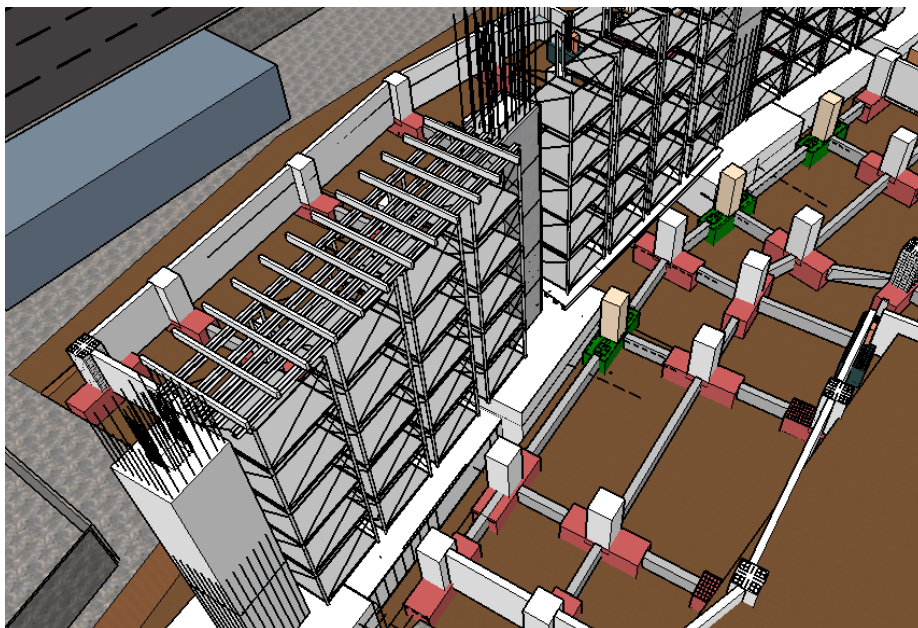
Render de colocación de vigas metálicas para viga riostra
